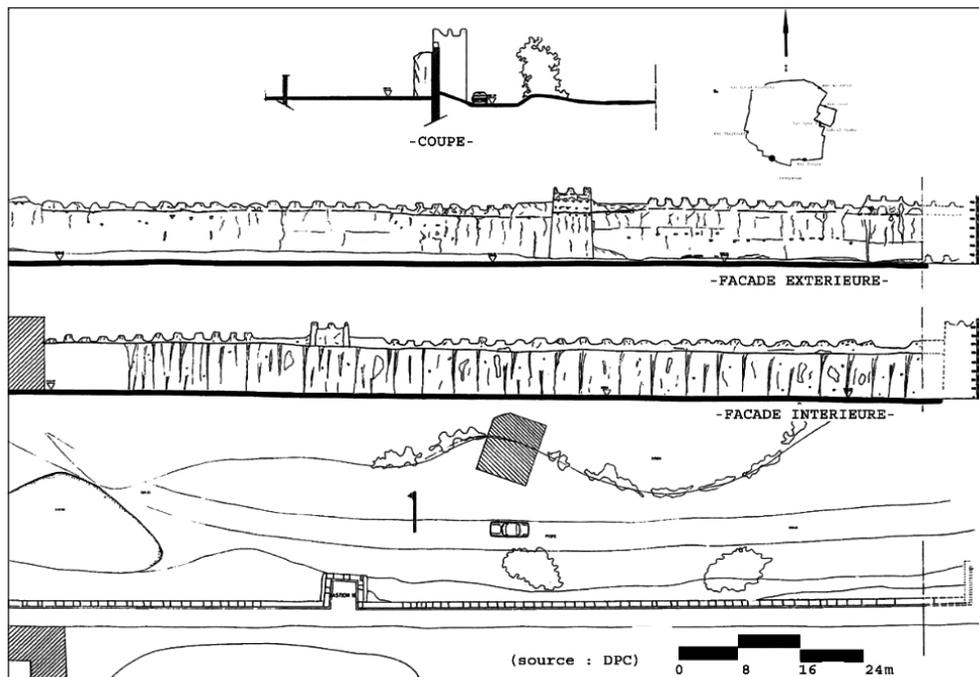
Muraille de Taroudant, côté Sud-Ouest, (Plan, façades et coupes), (Source: DPC).
